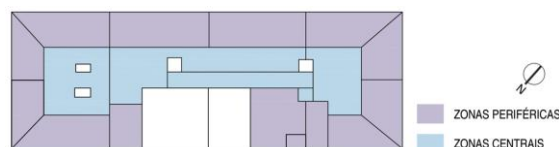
Zoneamento Típico da Climatização dos Pavimentos
